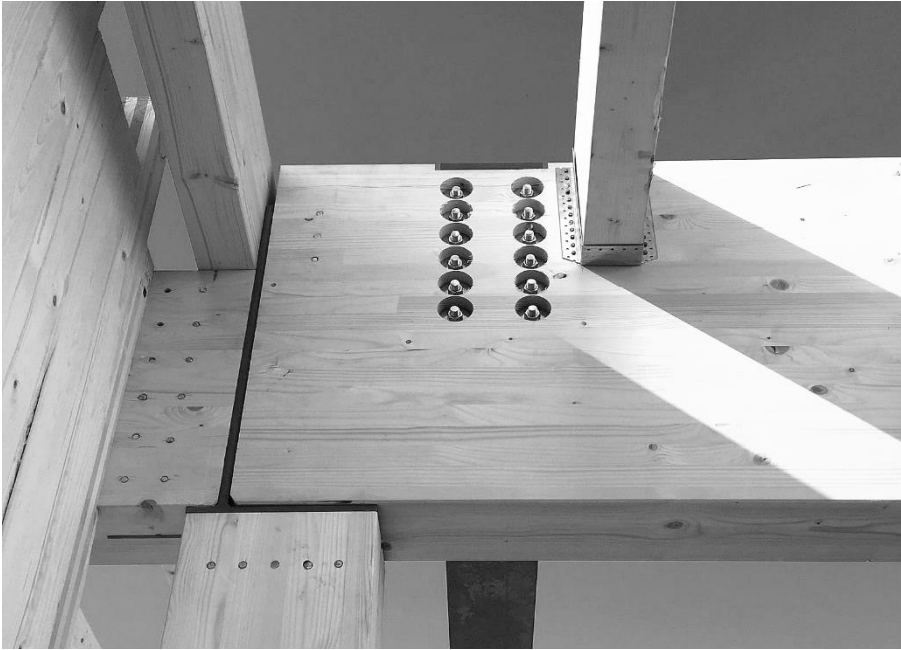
Auflagerdetail gemäß zuvor dargestellter CAD-Zeichnung nach der Montage
